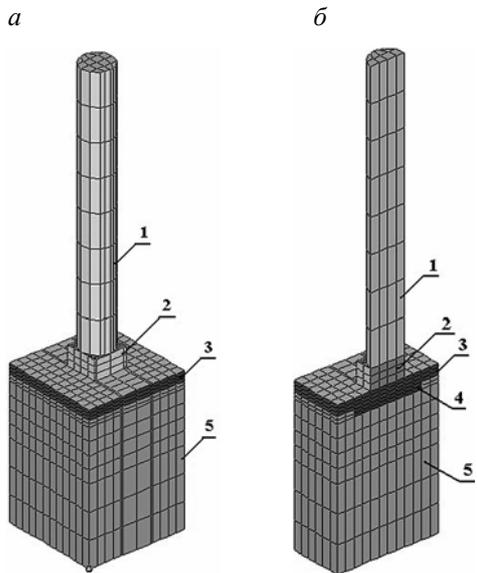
Расчетная схема без утепления (а) и с утеплением (б): 1 – колонна; 2 – стилобат; 3 – железобетонная плита; 4 – пенополистирол; 5 – кирпичная кладка
